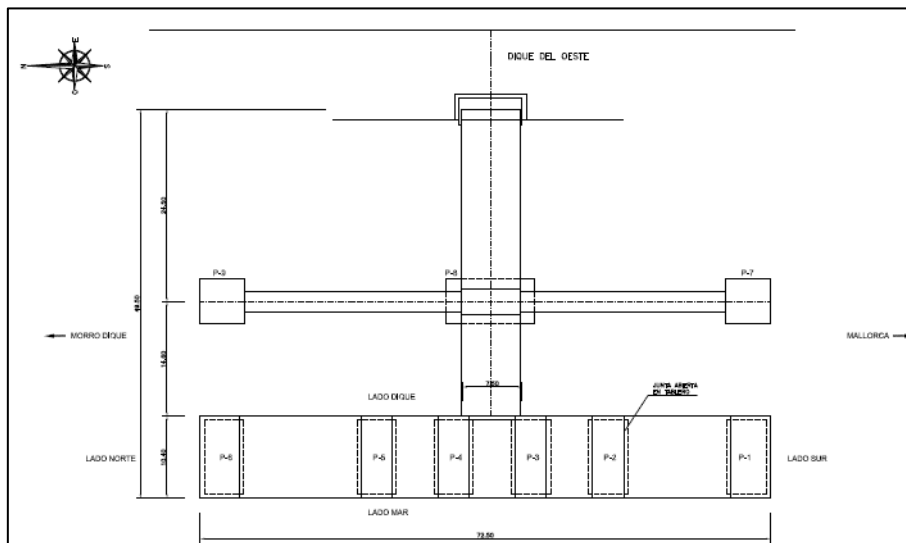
Planta del Terminal de EXOLUM antes del incidente con identificación de las pilas
